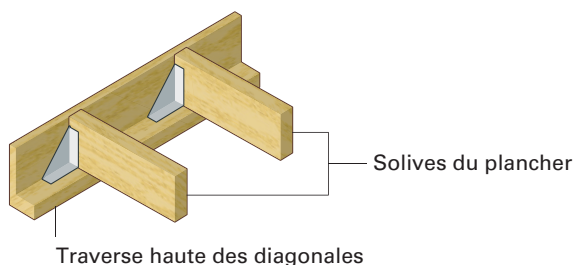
Pose des solives sur la traverse haute du niveau bas
